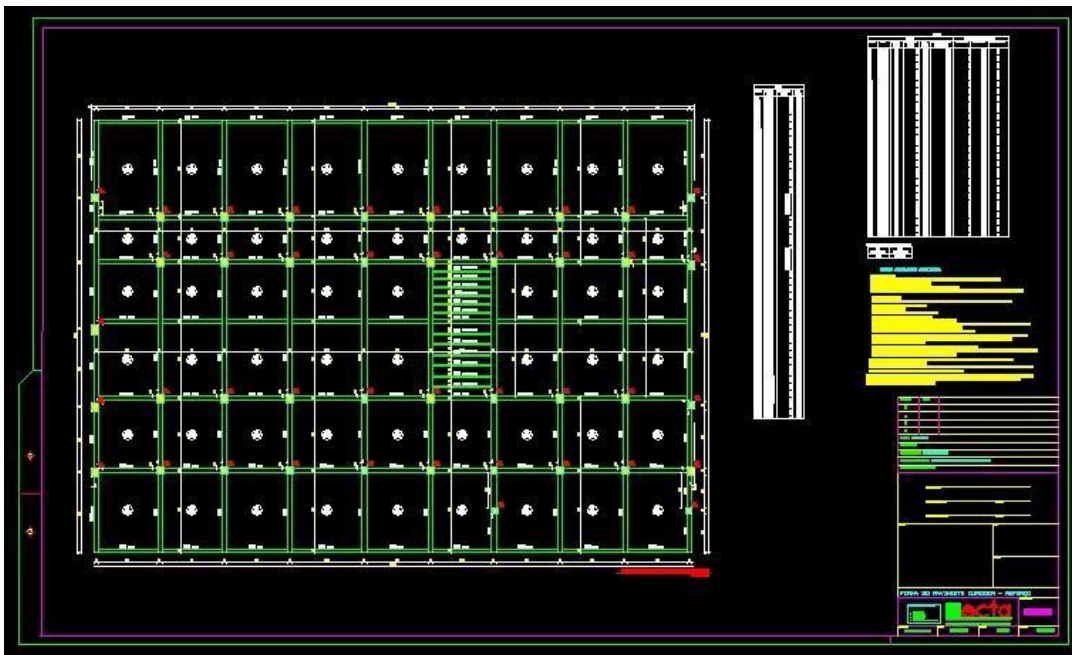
Forma do pavimento superior do projeto de reforço estrutural da edificação (Eberick). (Fonte: Autor)
